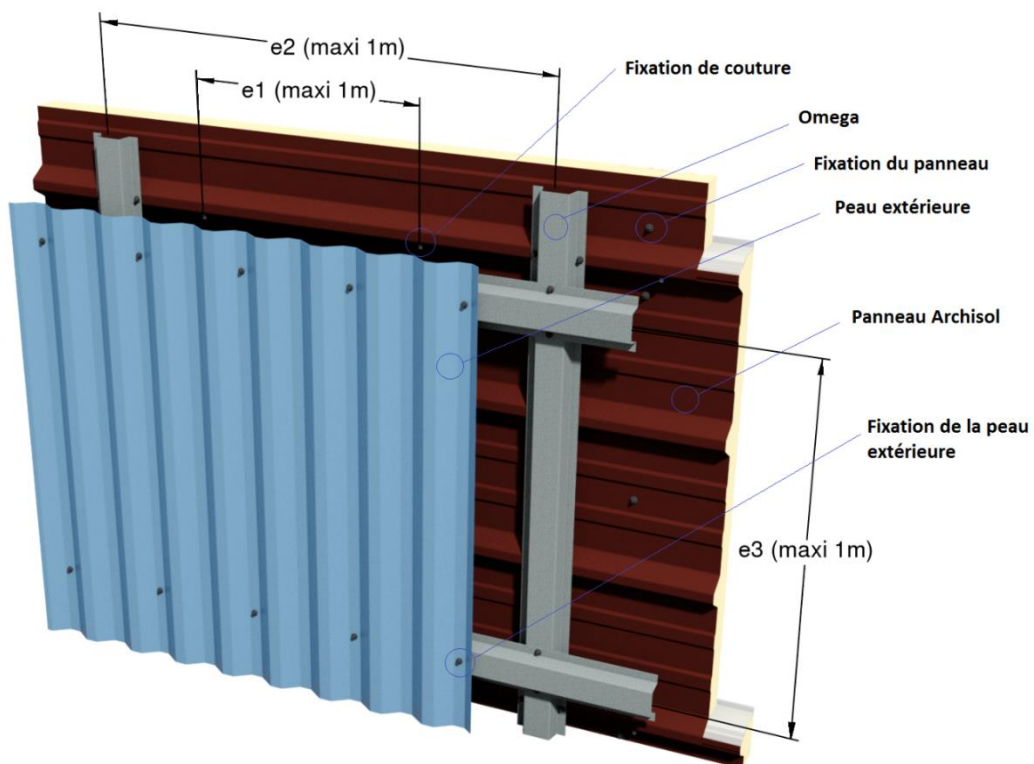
Vue 3D - Dessin de principe - panneau horizontal, double réseau d'ossature
